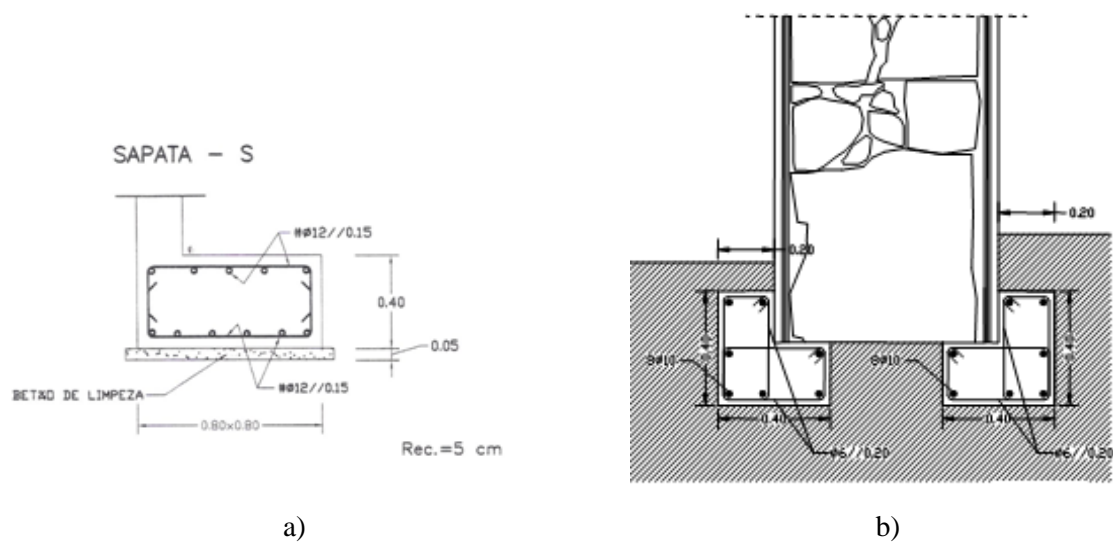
19 Fundações; a) Pormenor de uma sapata; b) Reforço de uma fundação, [37].
